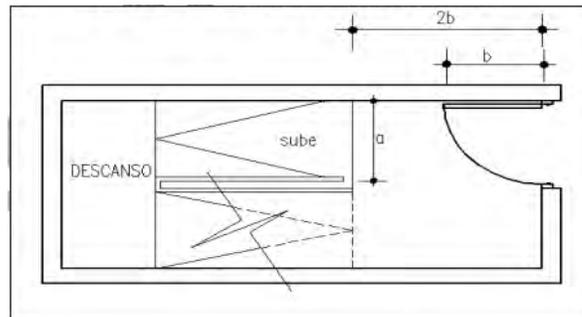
Distancia de la puerta al acceso a la rampa.
